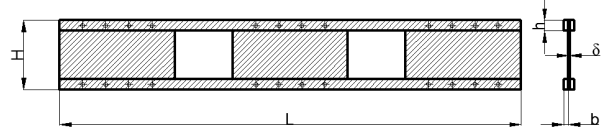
Конструкция балки перекрытия / The design of floor beams
